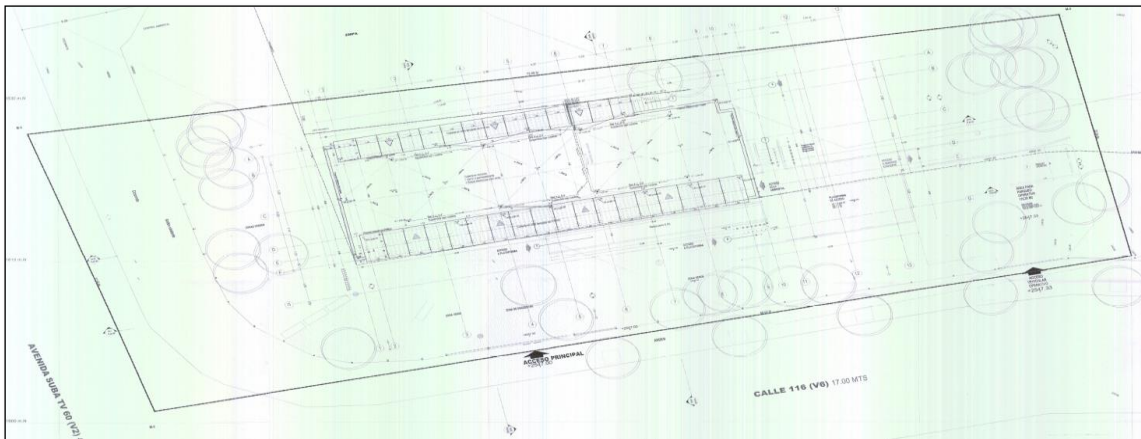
Tomado de plano de licencia de construcción- Fuente: Archivos EAAB-ESP
